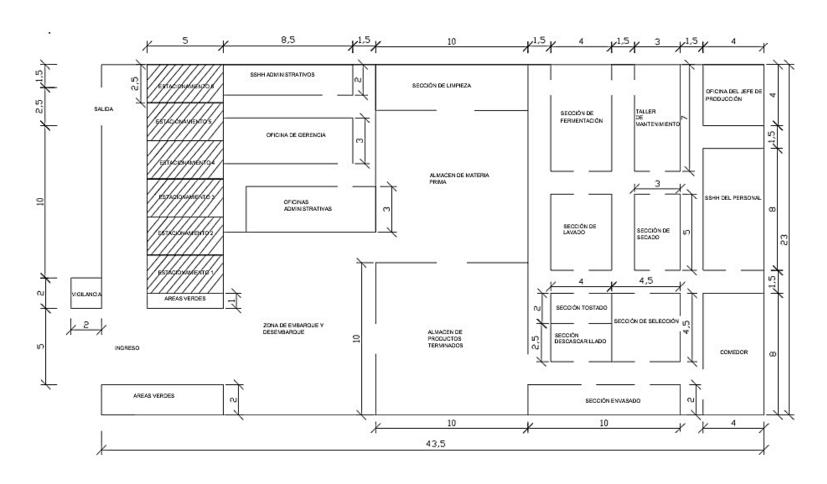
Plano de planta procesadora de cacao tostado en grano
